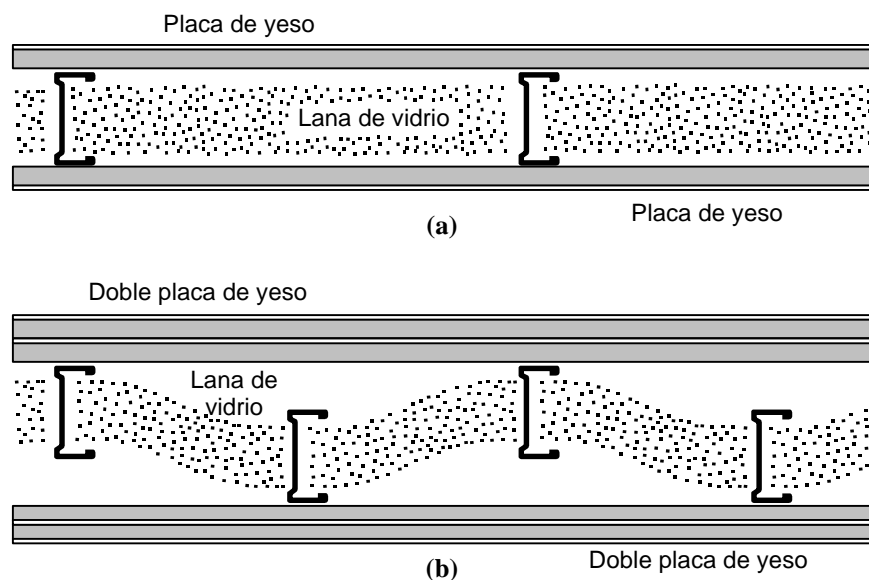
(a) Vista superior en corte de un montaje de placas de roca de yeso con estructura formada por perfiles de chapa. (b) Estructura alternada sin conexión rígida. Notar la diferencia de espesores a uno y otro lado de la pared.
